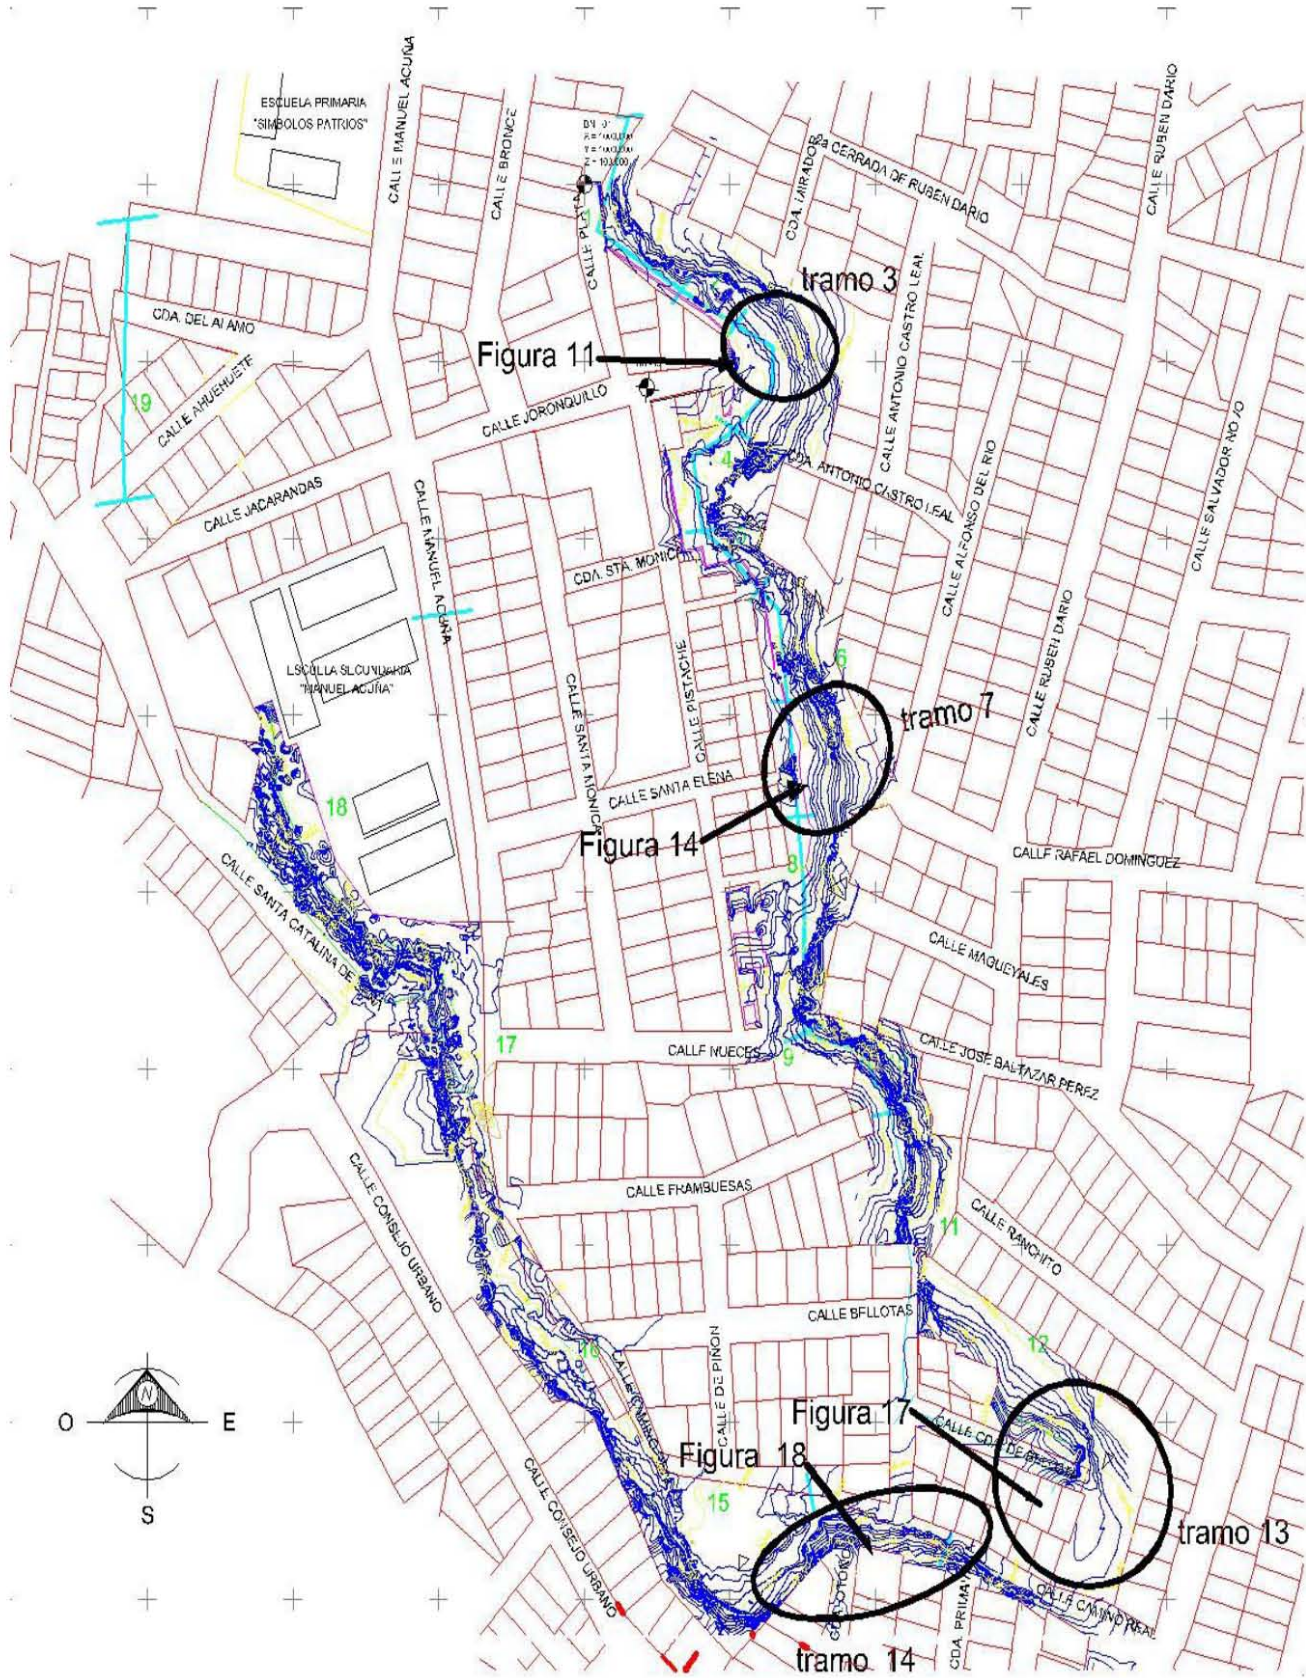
Localización de las zonas de bajo riesgo en el tramo.
